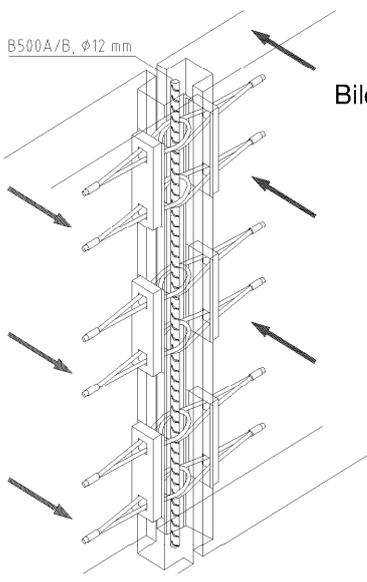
Beanspruchung senkrecht zu Fugenlängsrichtung und Wandebene
